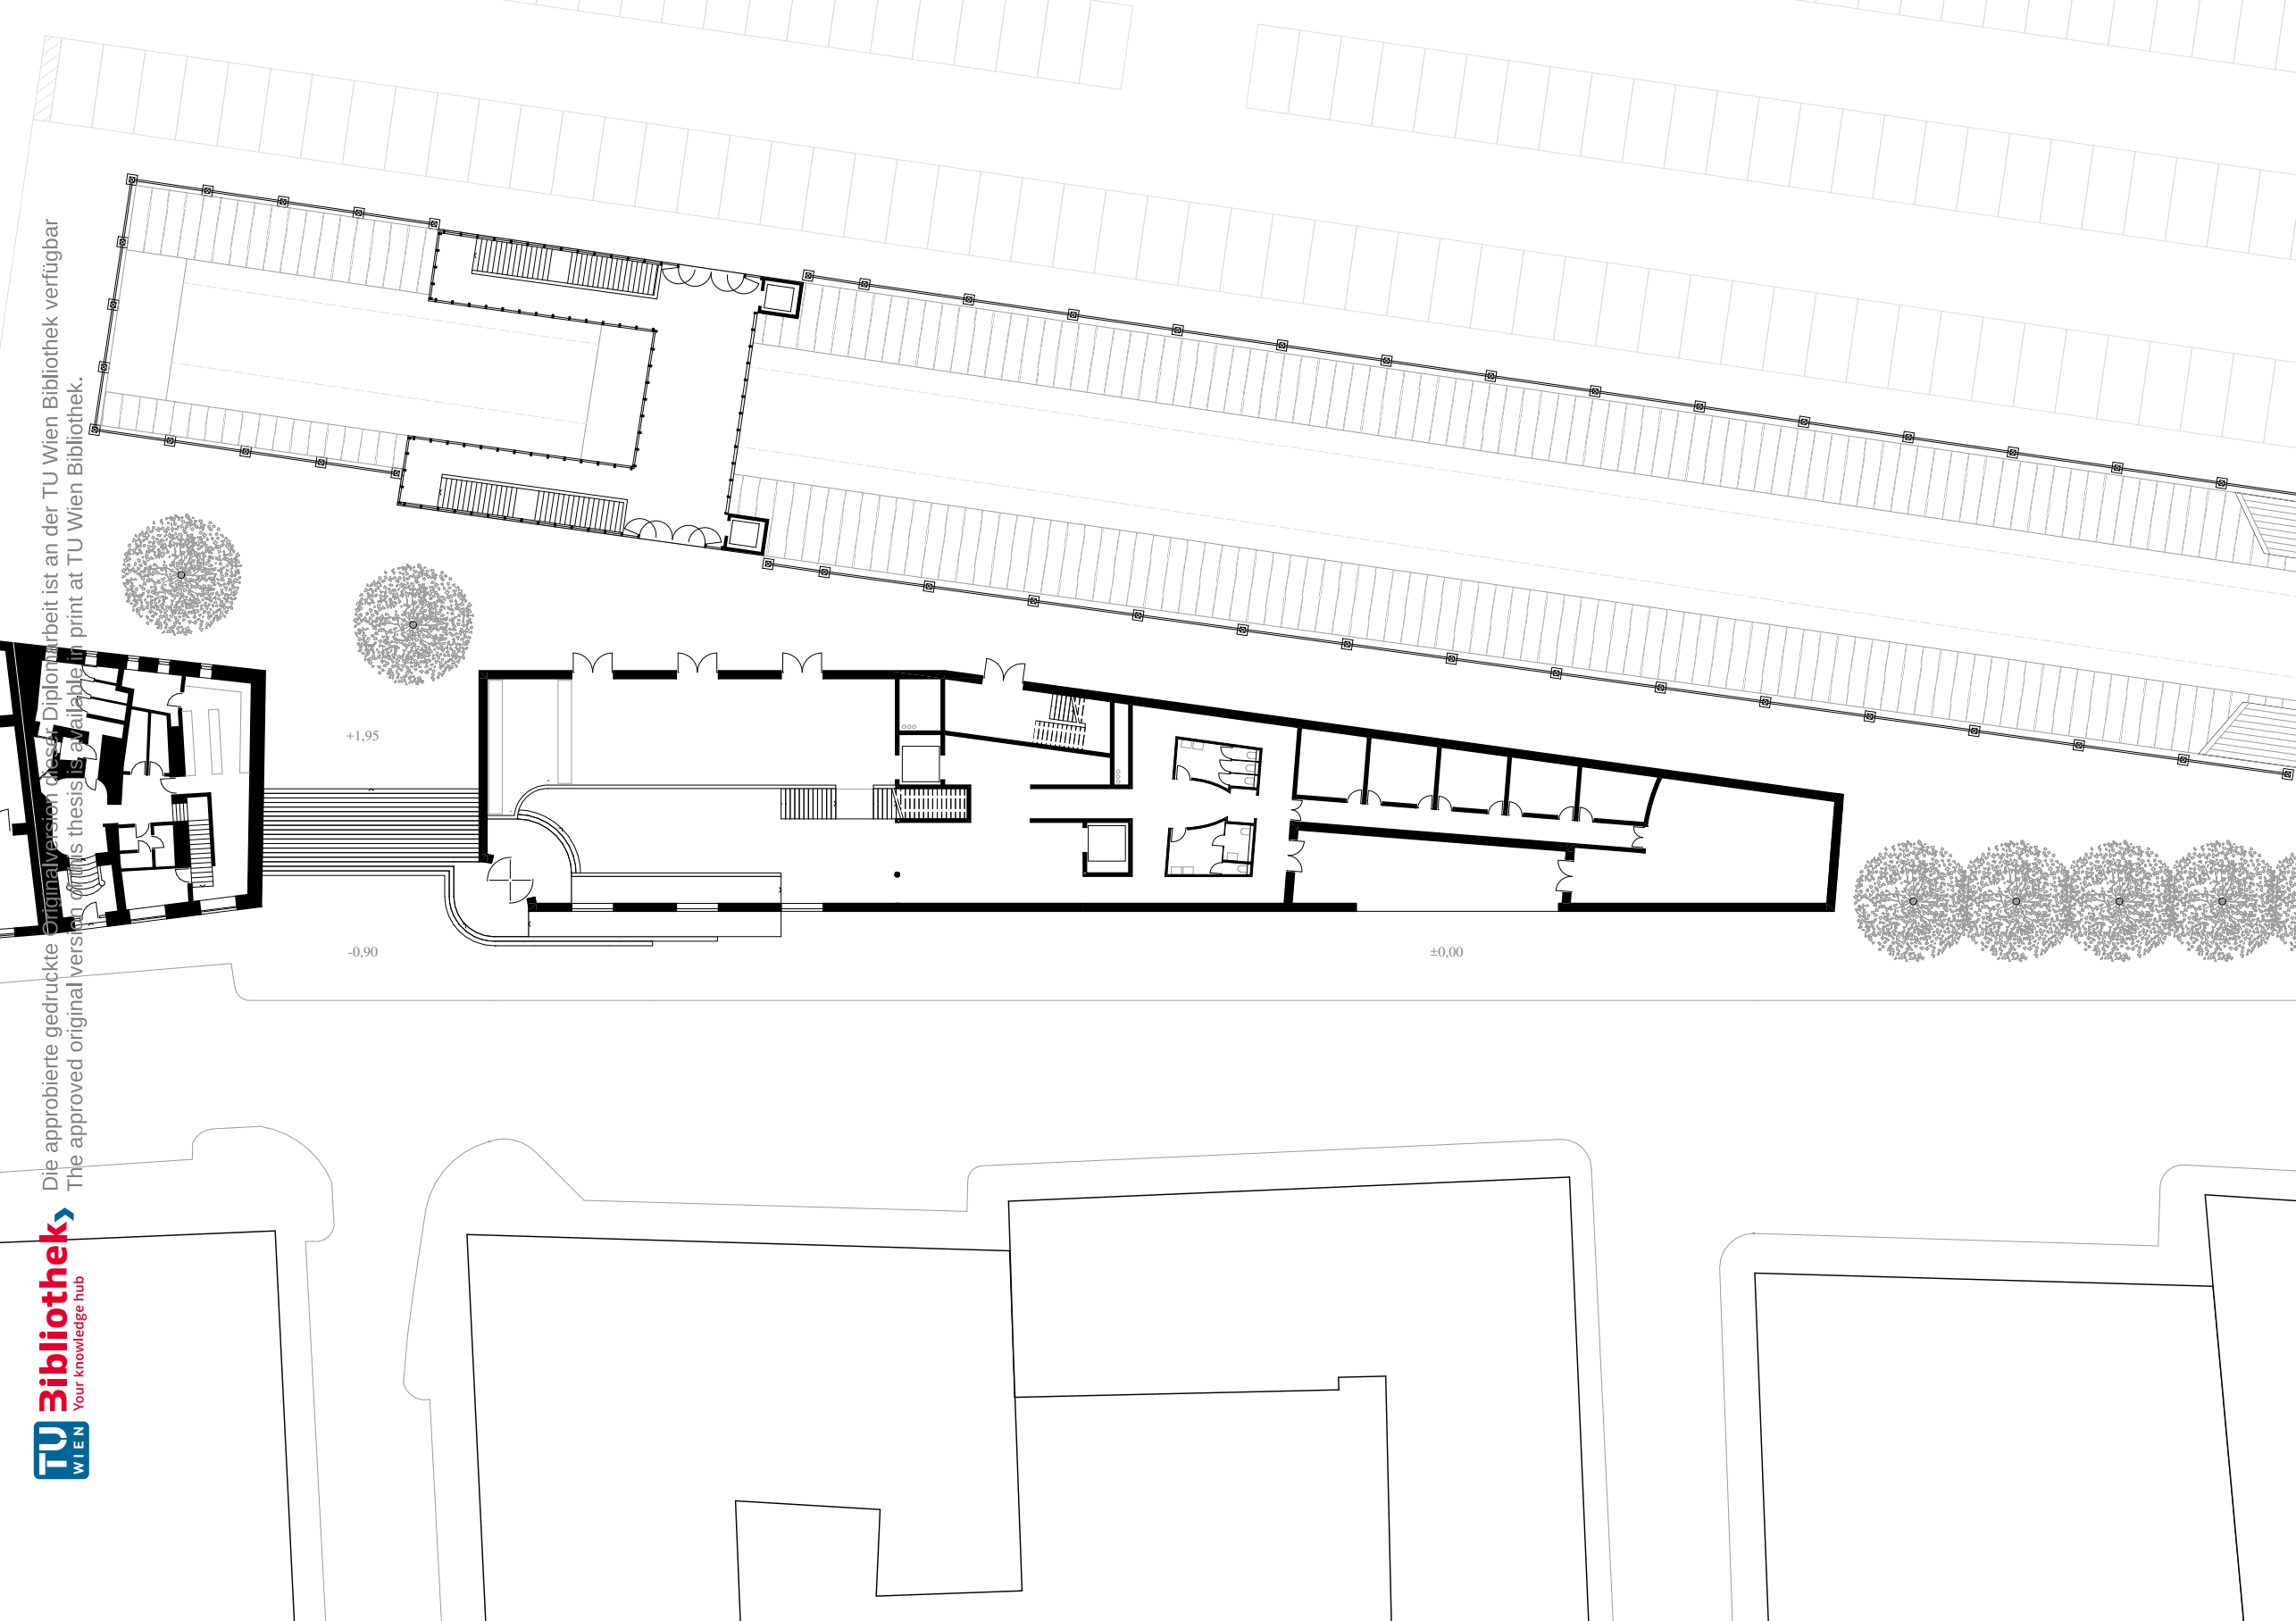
/ Lageplan M 1:5000 (Plan erstellt von PB) <
